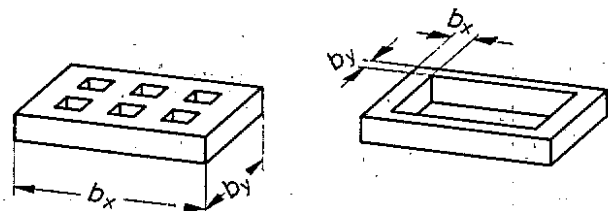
Maßgebende Breiten für den Grundbruchnachweis bei durchbrochenen Fundamentgrundrissen
